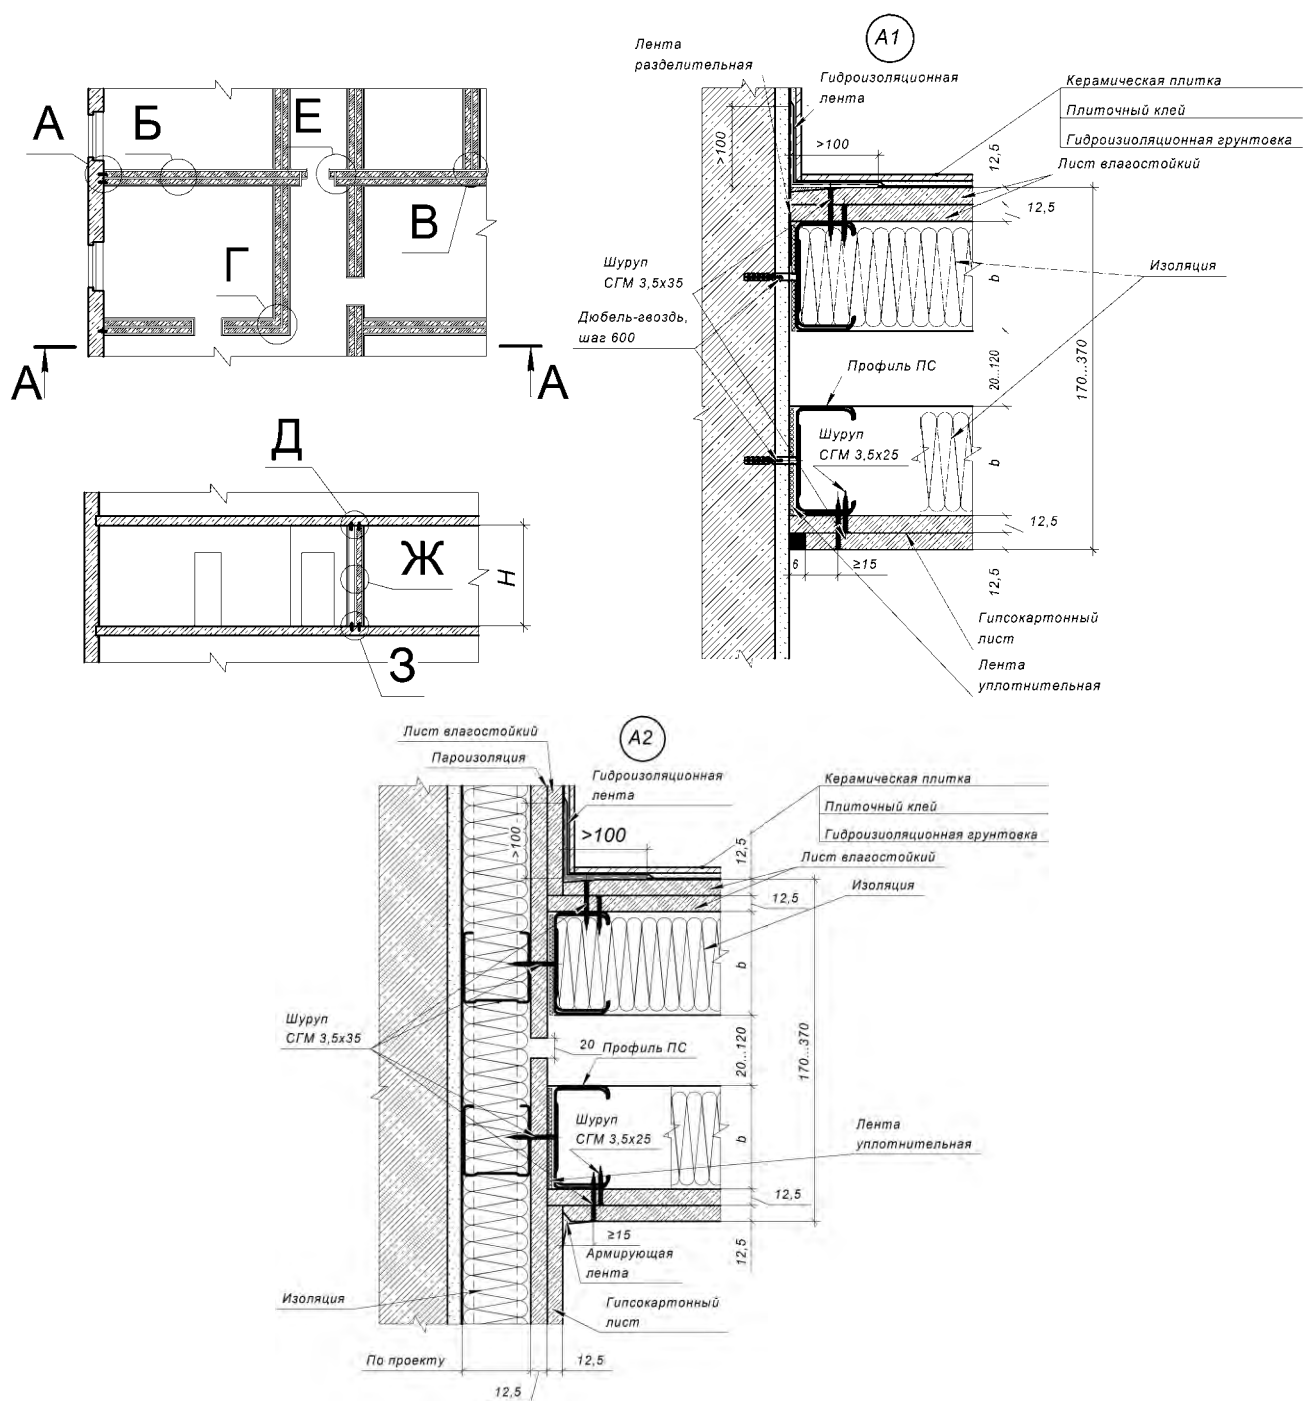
Фрагмент плана перегородок и конструктивные решения узлов А1, А2
